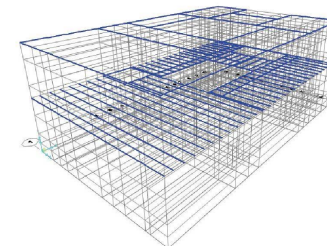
Elementos que conforman las vigas de entepiso y cubierta de la edificación de MNR.
